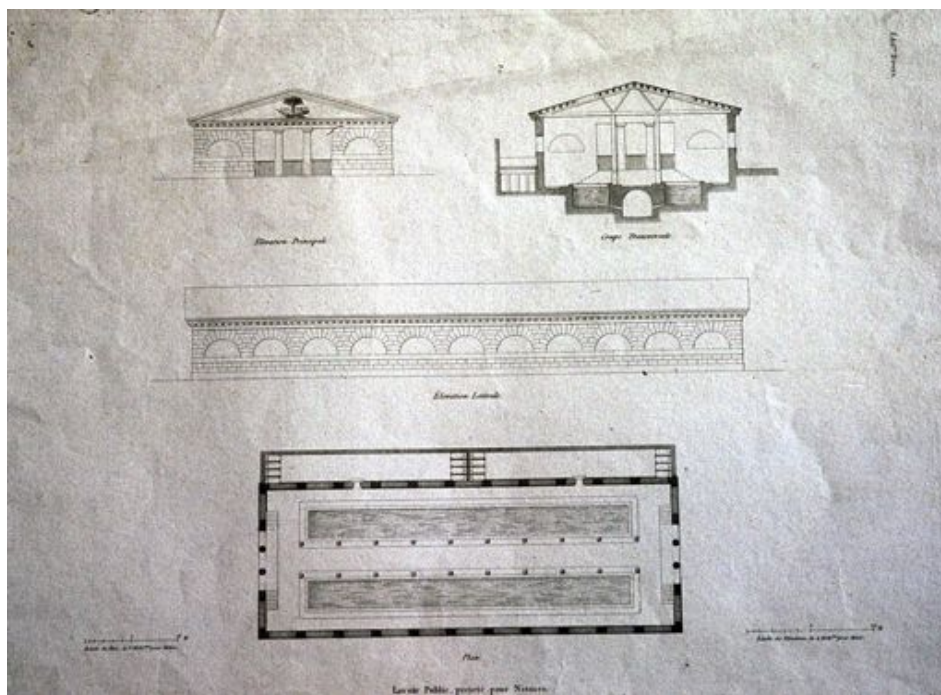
Plan et élévation des lavoirs projetés par Raymond à l'emplacement de l'actuelle place d'Assas - (AN)
